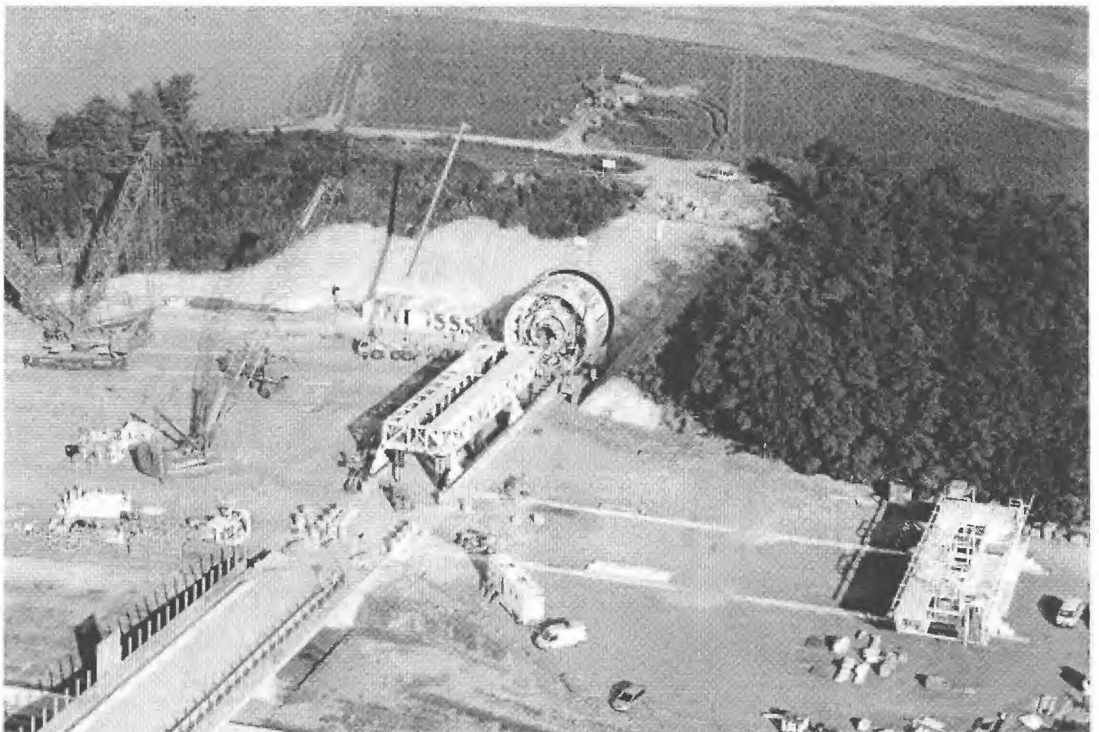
Montage der Tunnelbohrmaschine, Stierschweifeltunnel West
